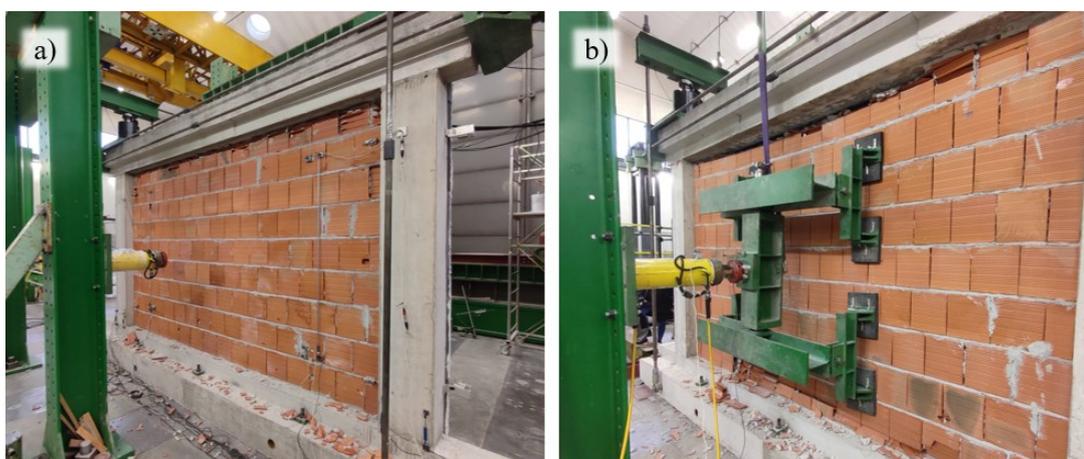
Raffigurazione della prova nel piano (a) e fuori piano (b).
